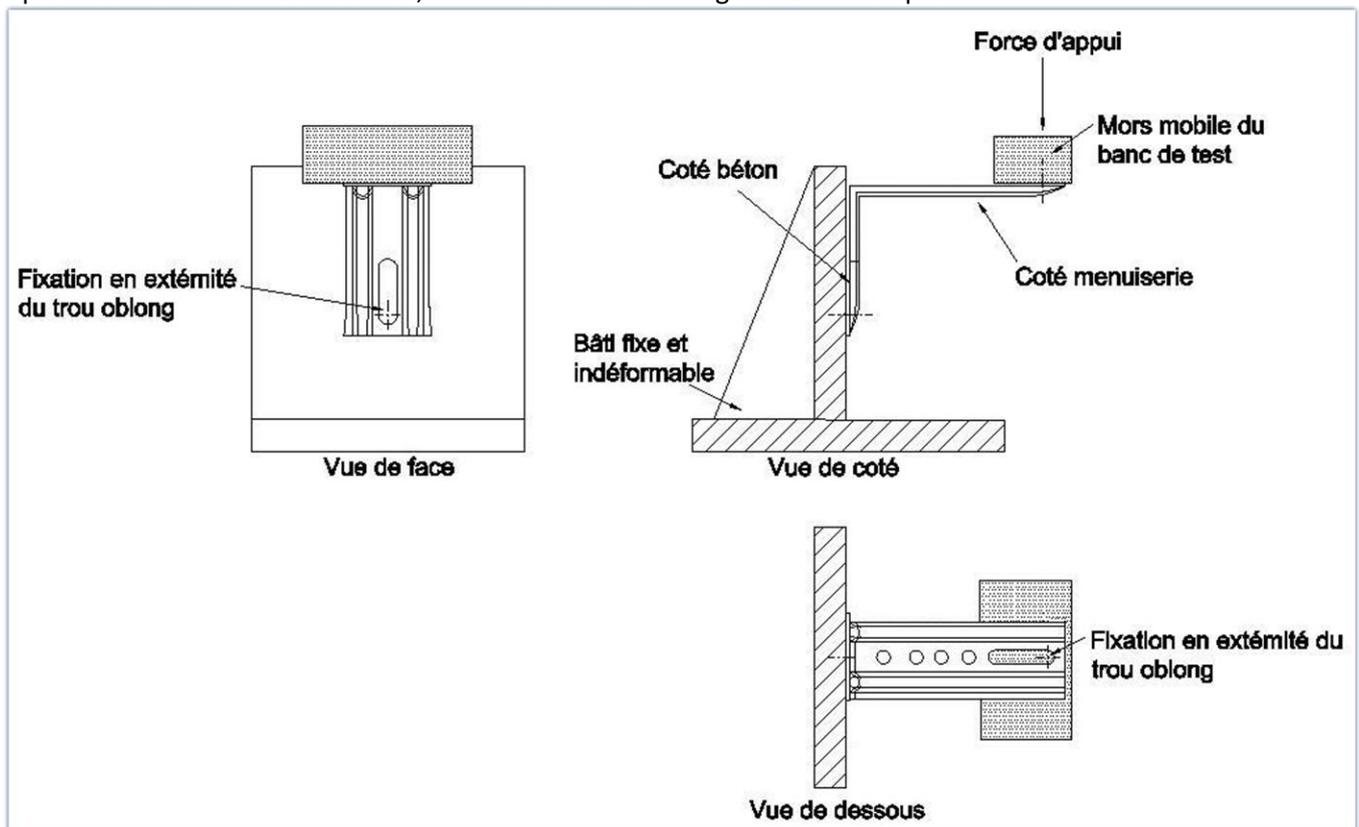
Schéma du montage pour l'essai en flexion de pattes de fixation : cas d'une patte nervurée
